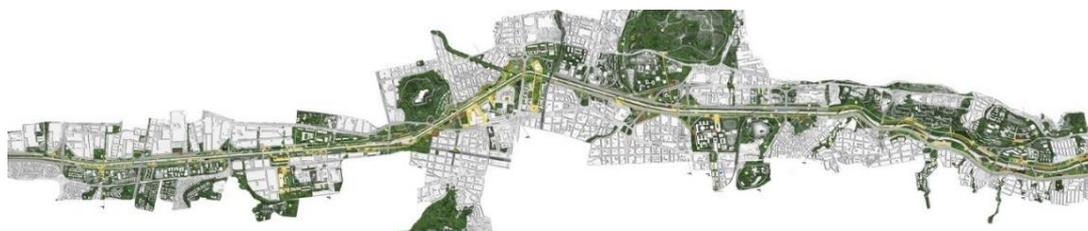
Planta de implantação da proposta de intervenção. Fonte: Archdaily, 2014.
